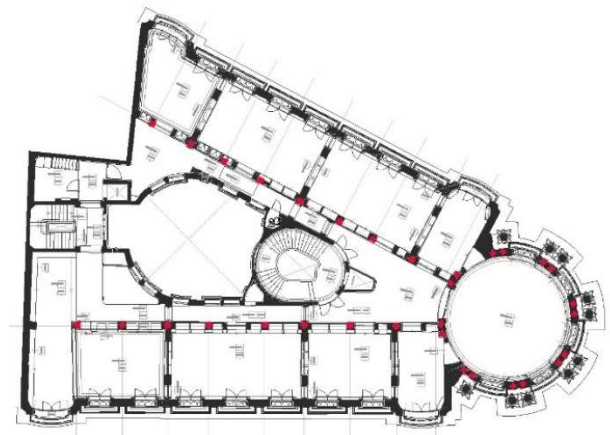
Vista de planta tipo, con los pilares de hormigón marcados en rojo.
